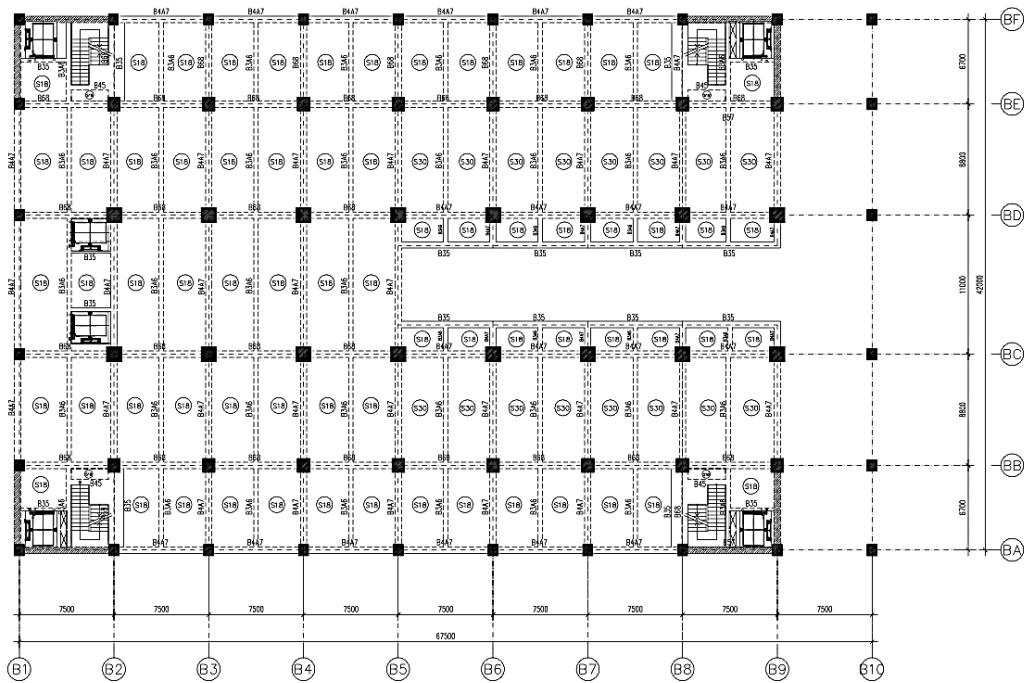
Denah pembalokan Lantai 3 Gedung Pelayanan
